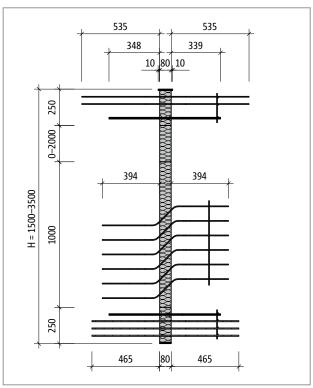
Schöck Isokorb® T type W-M1-R90: Product layout; Fire protection board top and bottom
